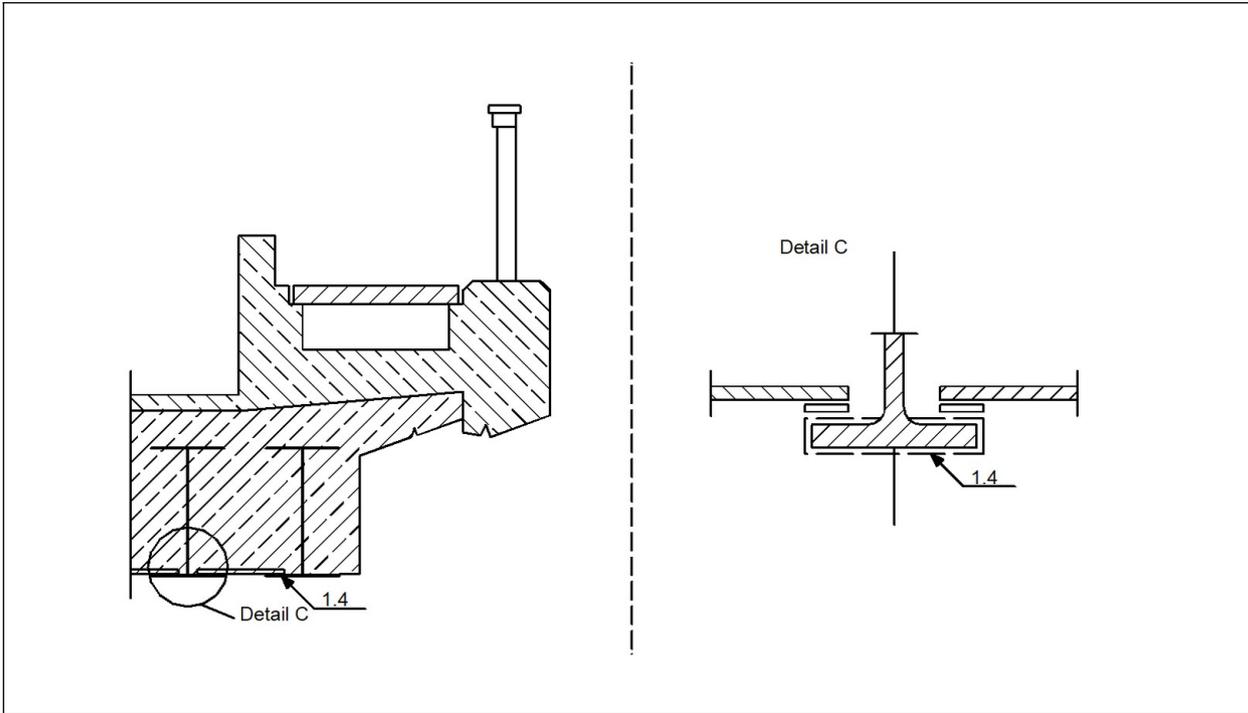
Detailquerschnitt in Verbundbauweise mit Betonfertigteilen und Ortbetonergänzung
